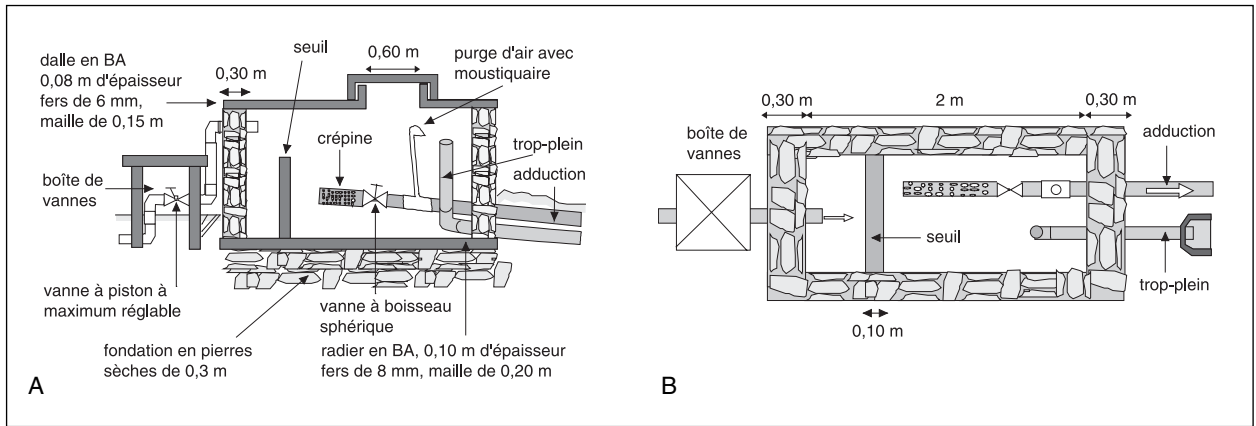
Bassin brise-charge en maçonnerie. A, vue en coupe. B, vue en plan.
